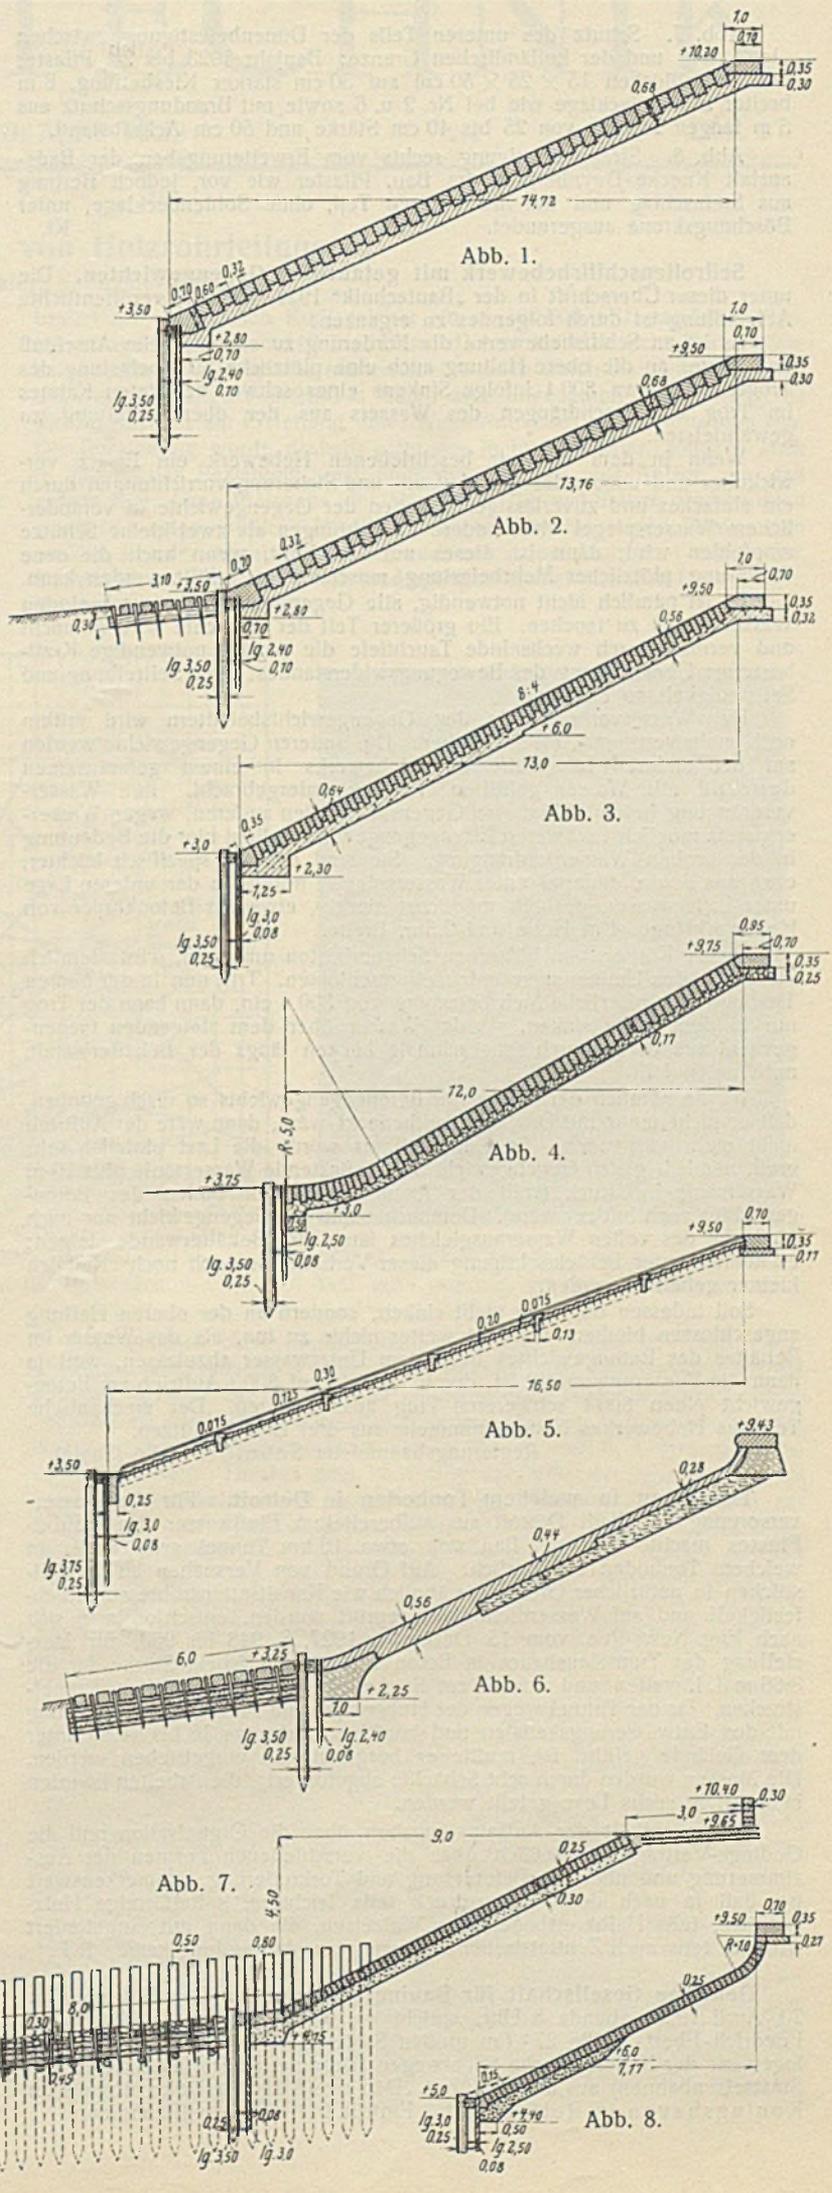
Schutz des unteren Teils der Dünenbefestigung zwischen „le Zoute“ und der holländischen Grenze: Baujahr 1923 bis 24, Pflaster aus Betonblöcken $15 \times 25 \times 50$ cm auf 30 cm starker Kiesbettung, 8 m breiter Sohlendecklage wie bei Nr. 2 u. 6 sowie mit Brandungsschutz aus 5 m langen Pfählen von 25 bis 40 cm Stärke und 50 cm Achsabstand.
